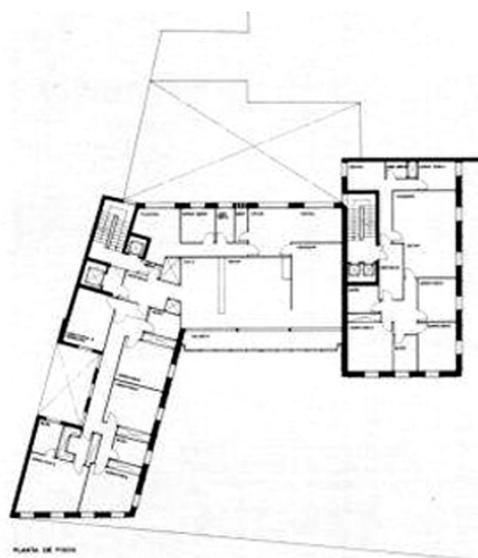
Planta tipo del Edificio Moroder. Fuente: COACV
